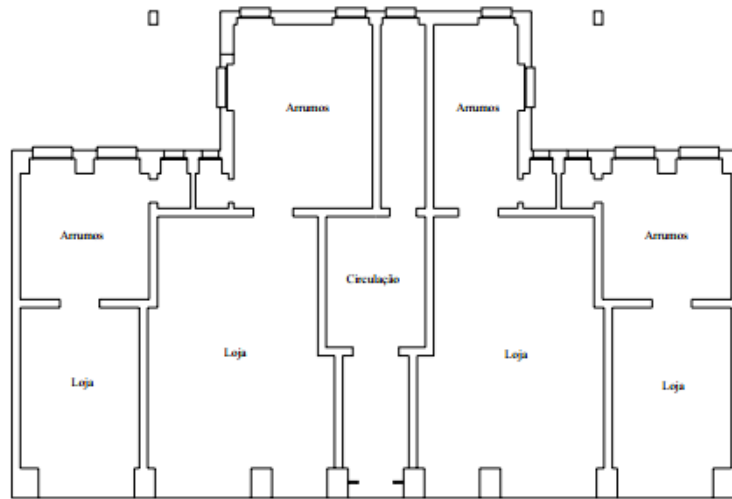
Planta de arquitetura do piso térreo do edifício em estudo (Lamego, 2014)
